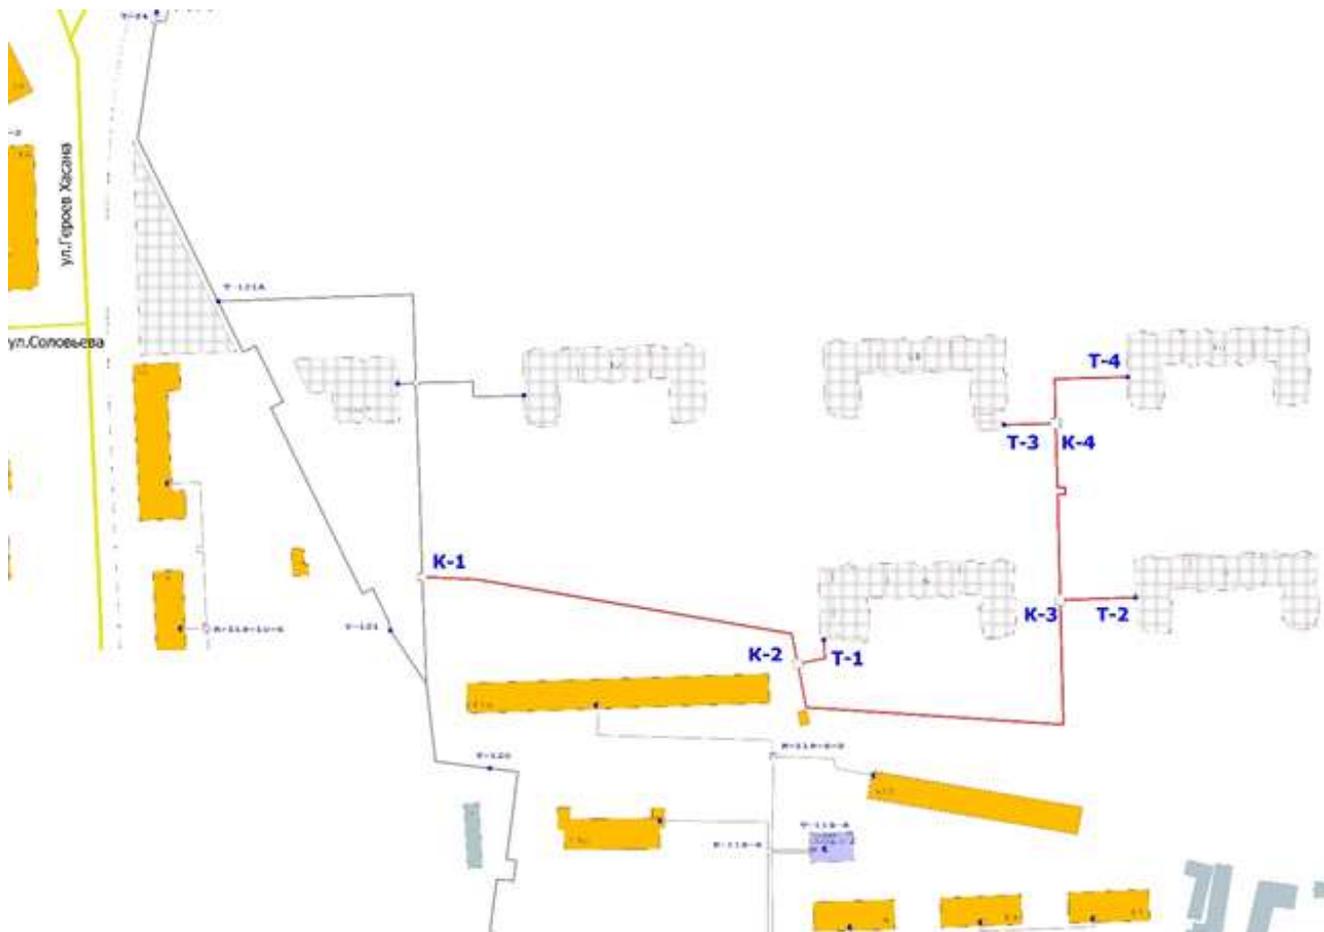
Ситуационный план развития системы теплоснабжения «Комплекса многоквартирных жилых домов по ул. Красные казармы, кв.272.»
